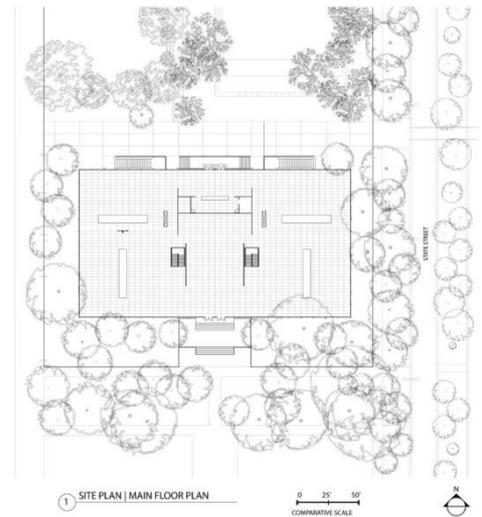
, Plano de situación de la restauración de Krueck + Sexton Architects
